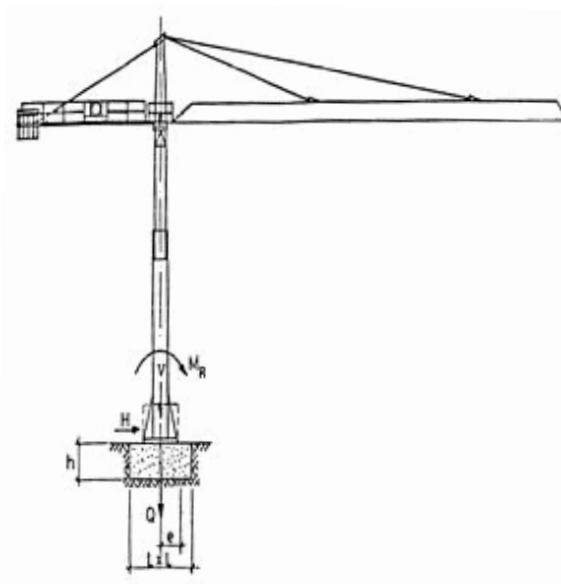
Cargas sobre la base del mástil para el cálculo de la zapata.
